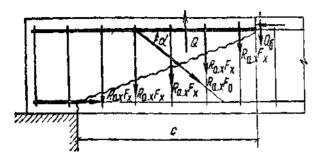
Схема усилий в сечении, наклонном к продольной оси железобетонного элемента, при расчете его по прочности на действие поперечной силы
